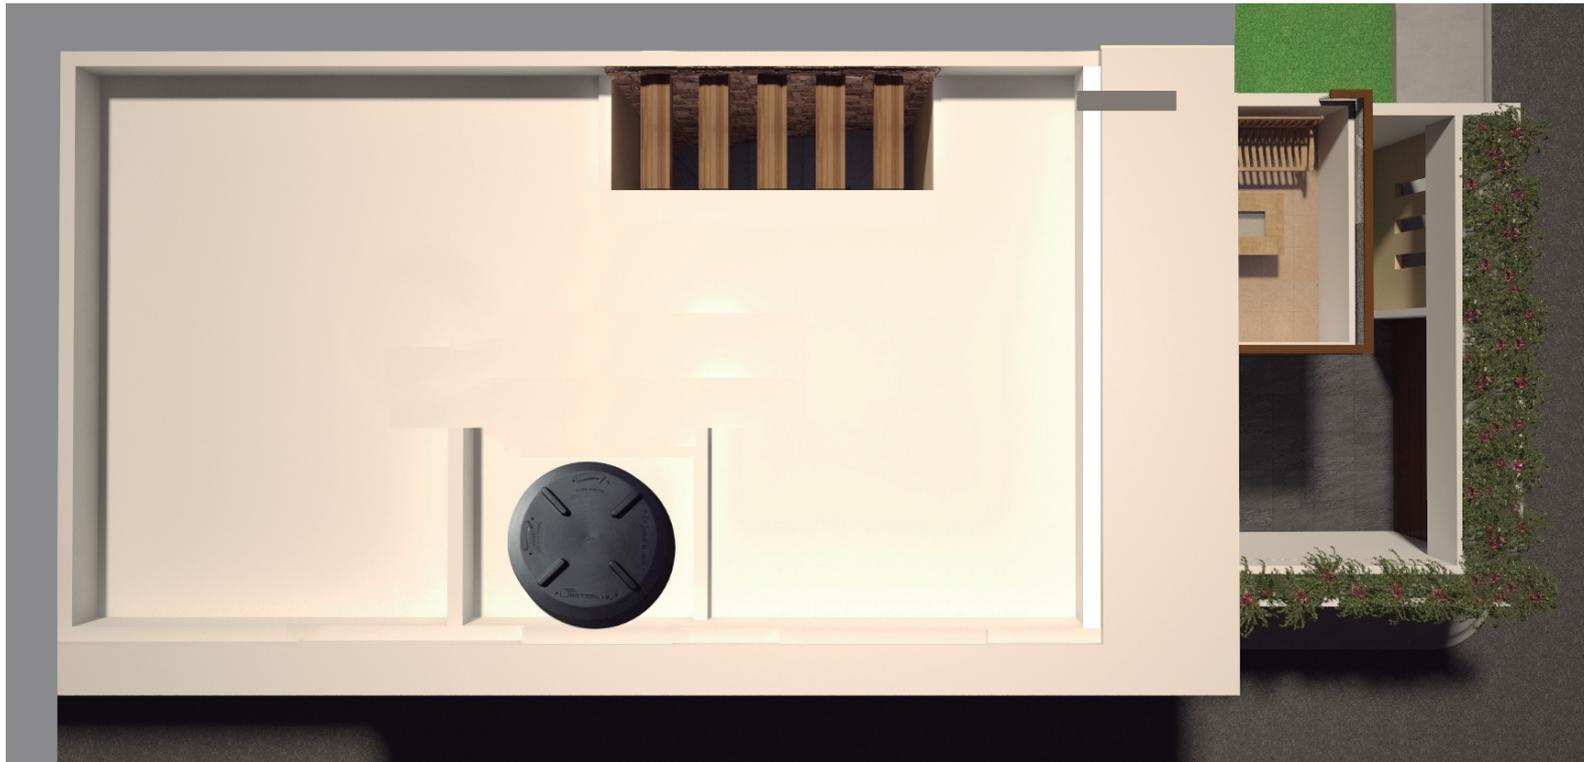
Render de planta de conjunto en perspectiva. Elaboración propia
